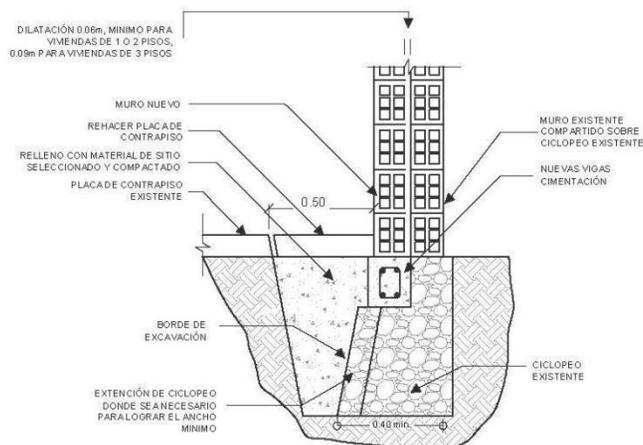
Nueva viga de cimentación en concreto reforzado para muros perimetrales nuevos juntos a muros compartidos.
